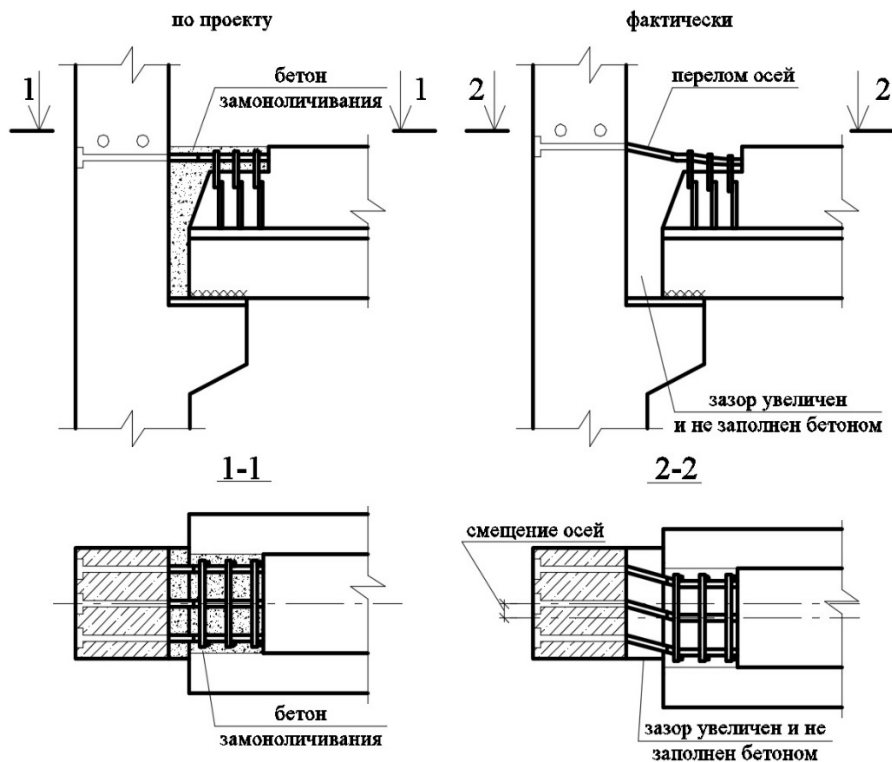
Смещение ригеля относительно колонны каркаса
